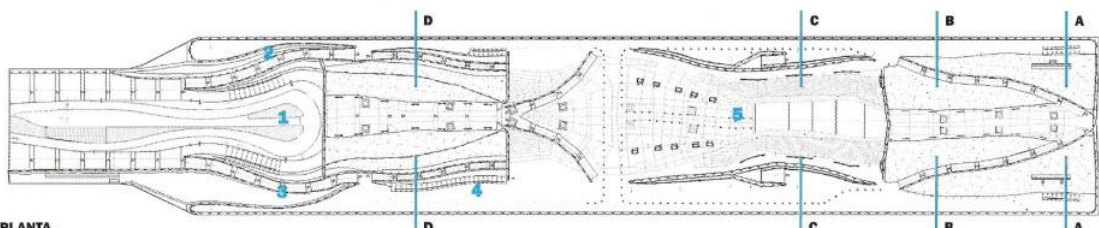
Plano de localización del Terminal de pasajeros en Yokohama FOA
